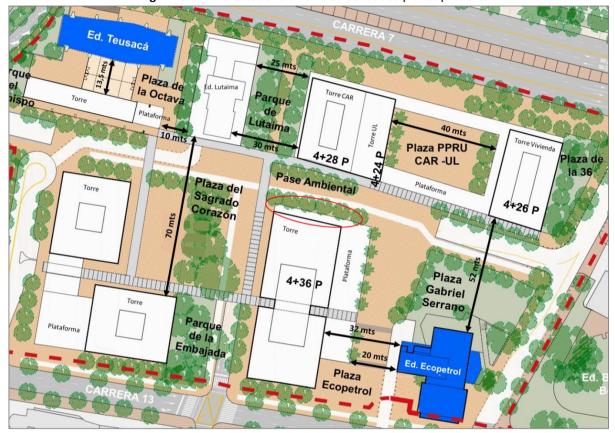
Aislamientos entre Edificios de los dos planes parciales
